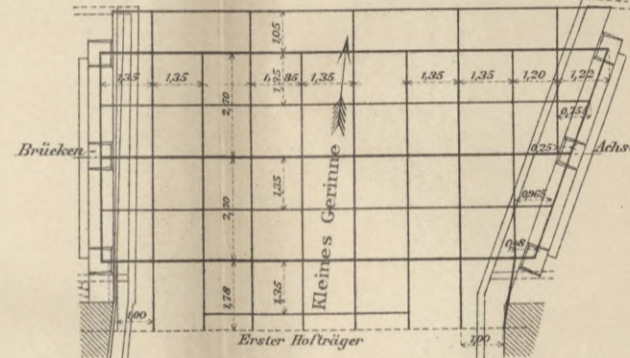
Grundriss-Anordnung der Brücke über der Schleuse. 1:200.
